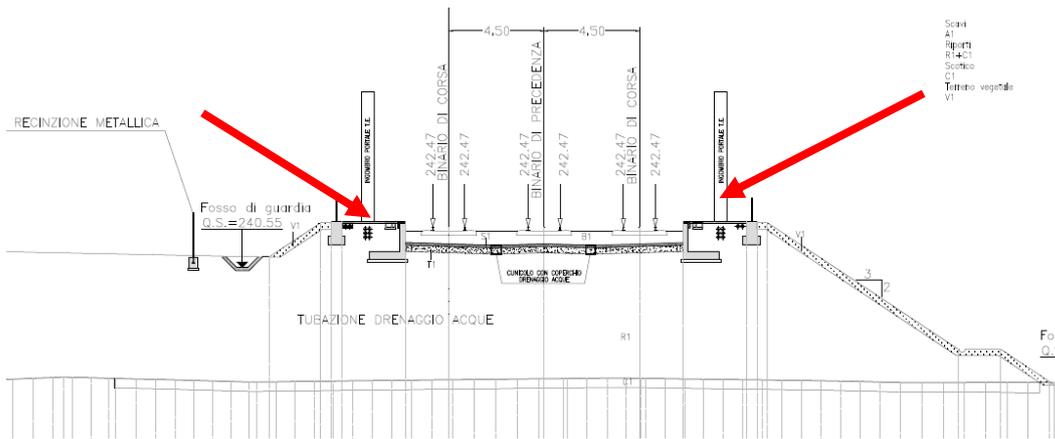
Sezione rilevato WBS RI110 – Le frecce rosse localizzano le banchine
